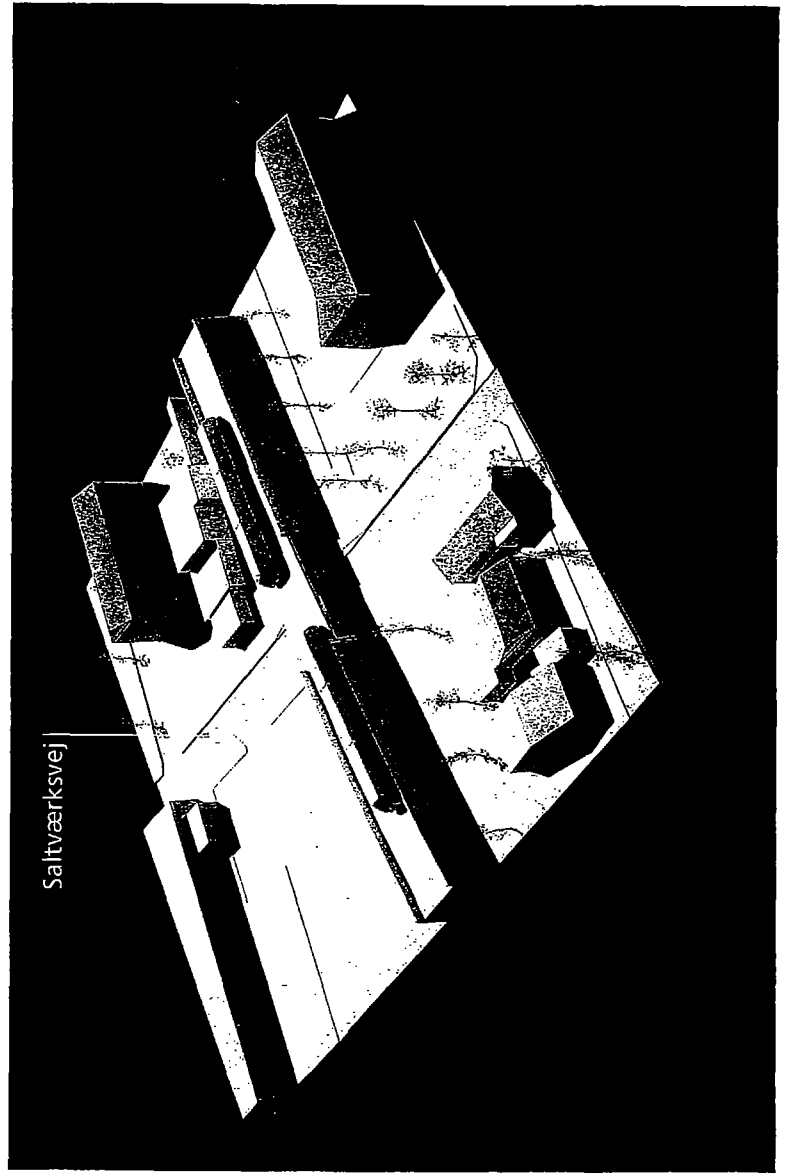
Sivetunnel ved Vægtergangen, modelfoto
